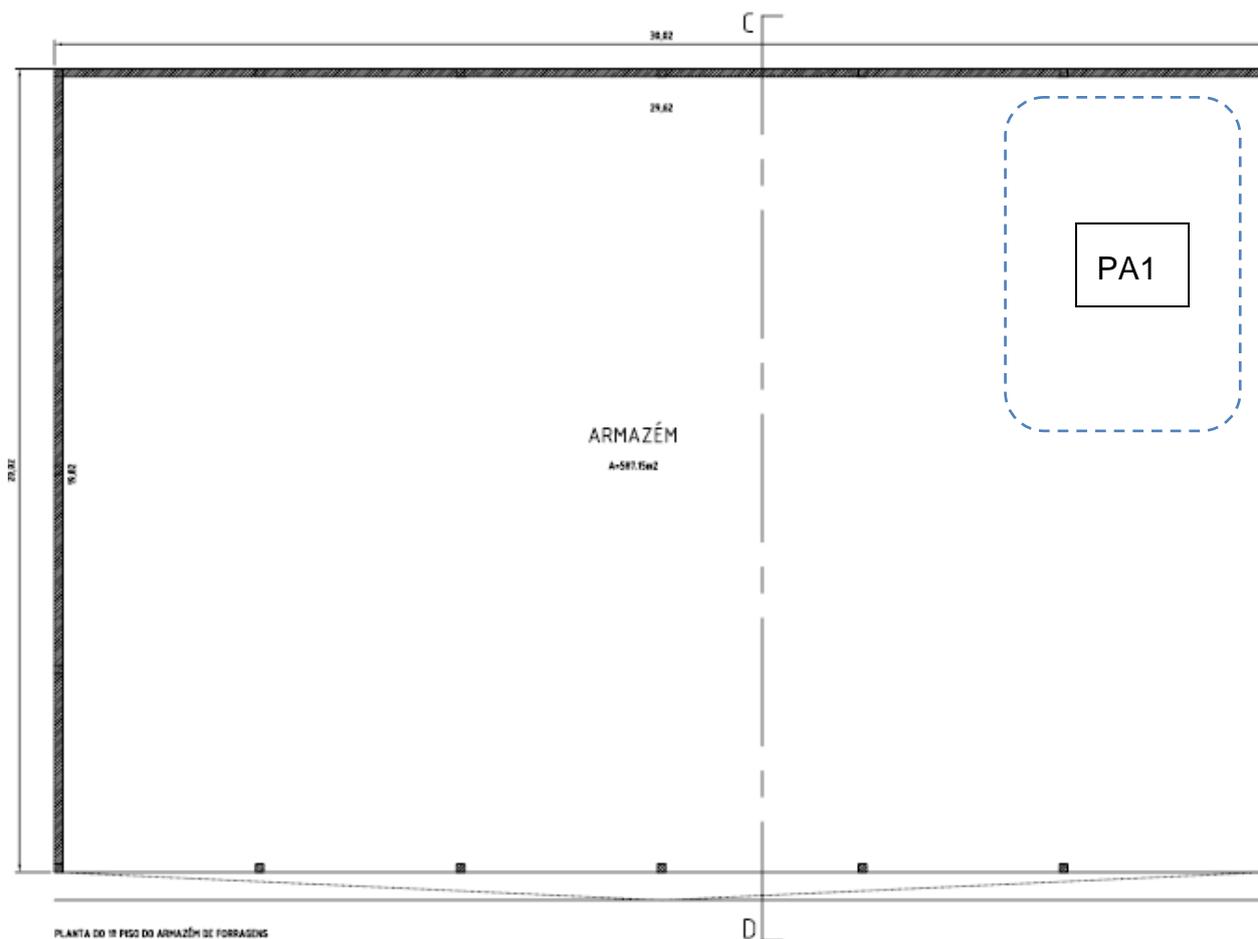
Localização do PA1 no Alpendre 1 da Área Edificada 2 (adaptado da planta de arquitetura).
